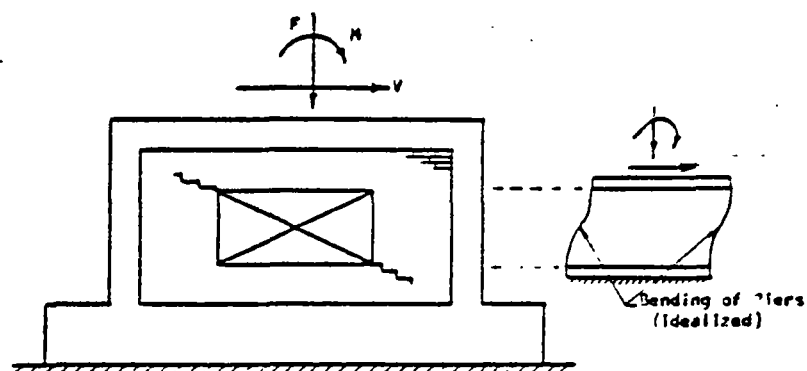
FISSURATION D'UN C.R AVEC OUVERTURE
